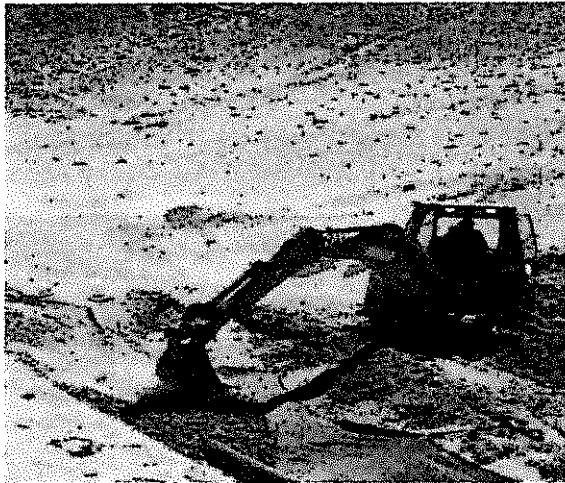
Relleno de la tubería de sub drenaje con equipo.
